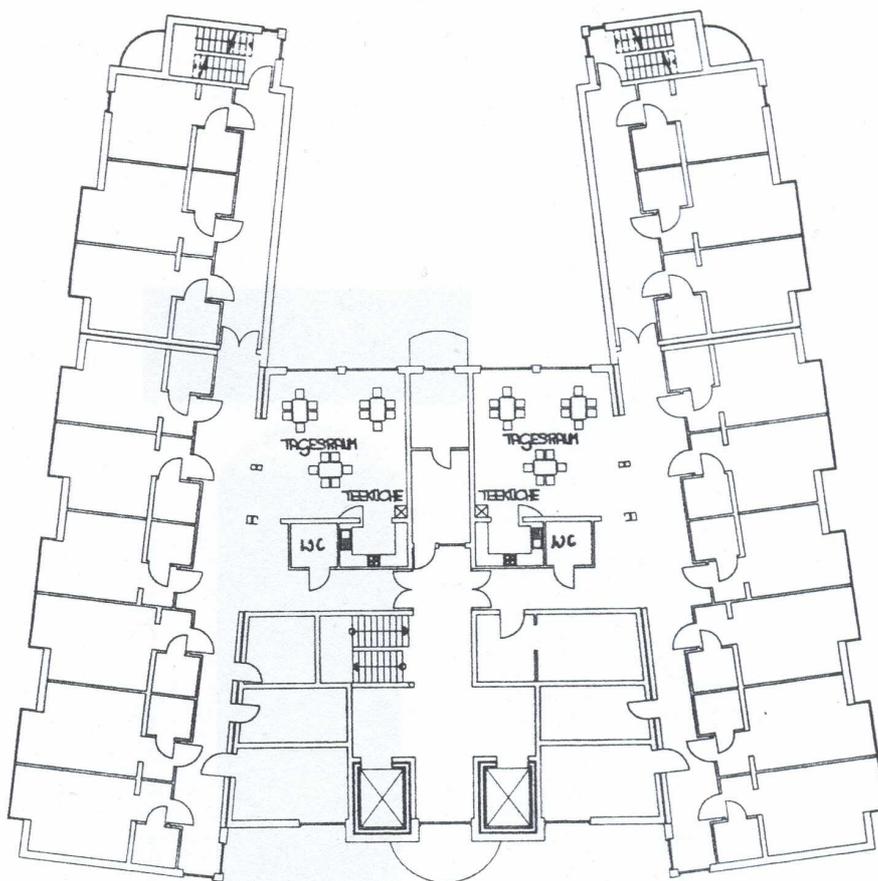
Grundrisszeichnung Buchen-Hof
